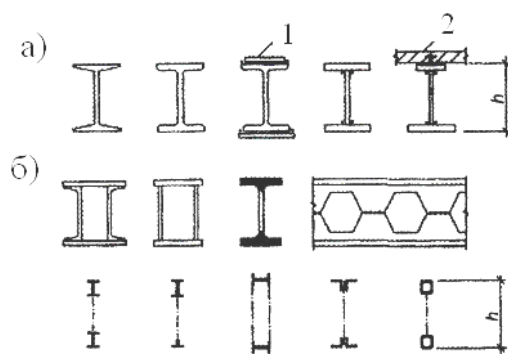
Типы сечений металлических балок перекрытий пролетом до 12 м (а) и более 12 м (б)
